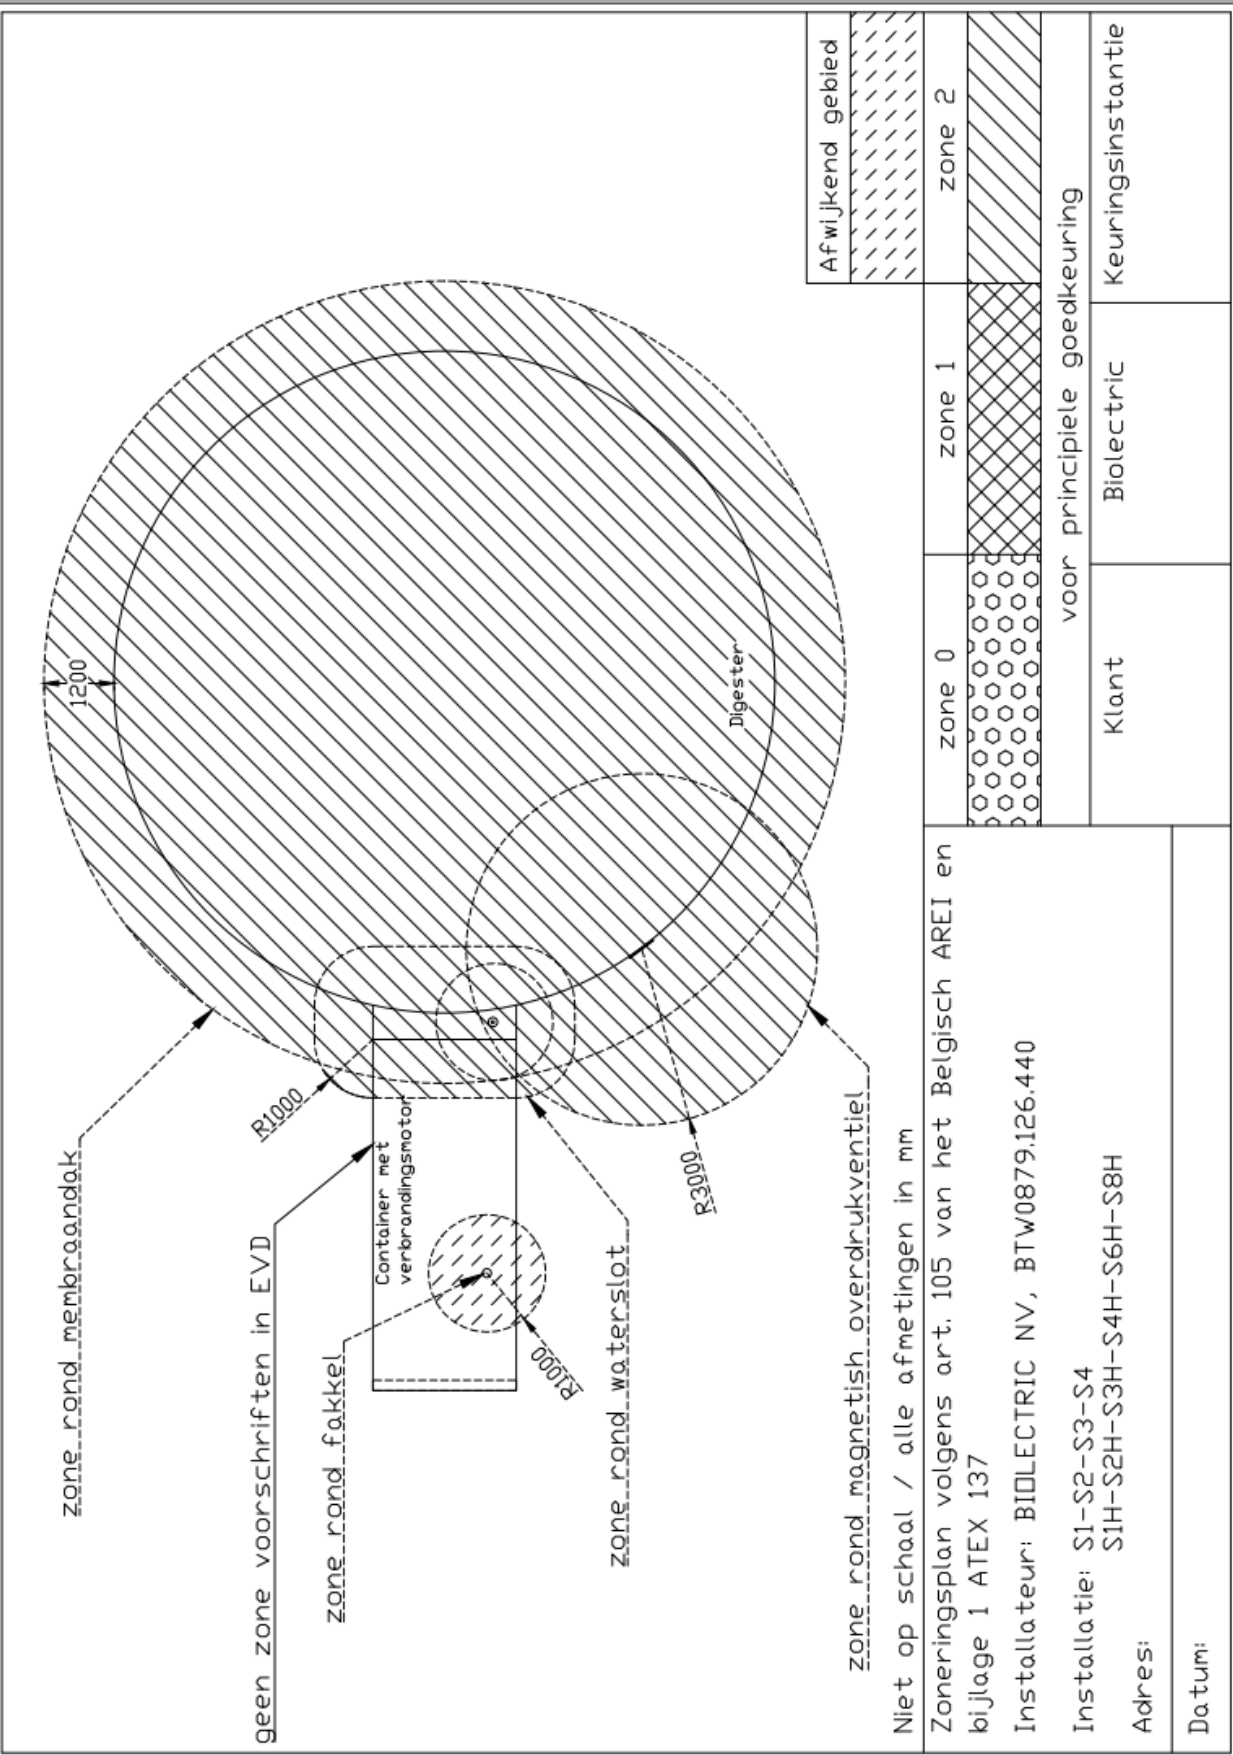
zoneringsplan zijaanzicht S1-S2-S3-S4
